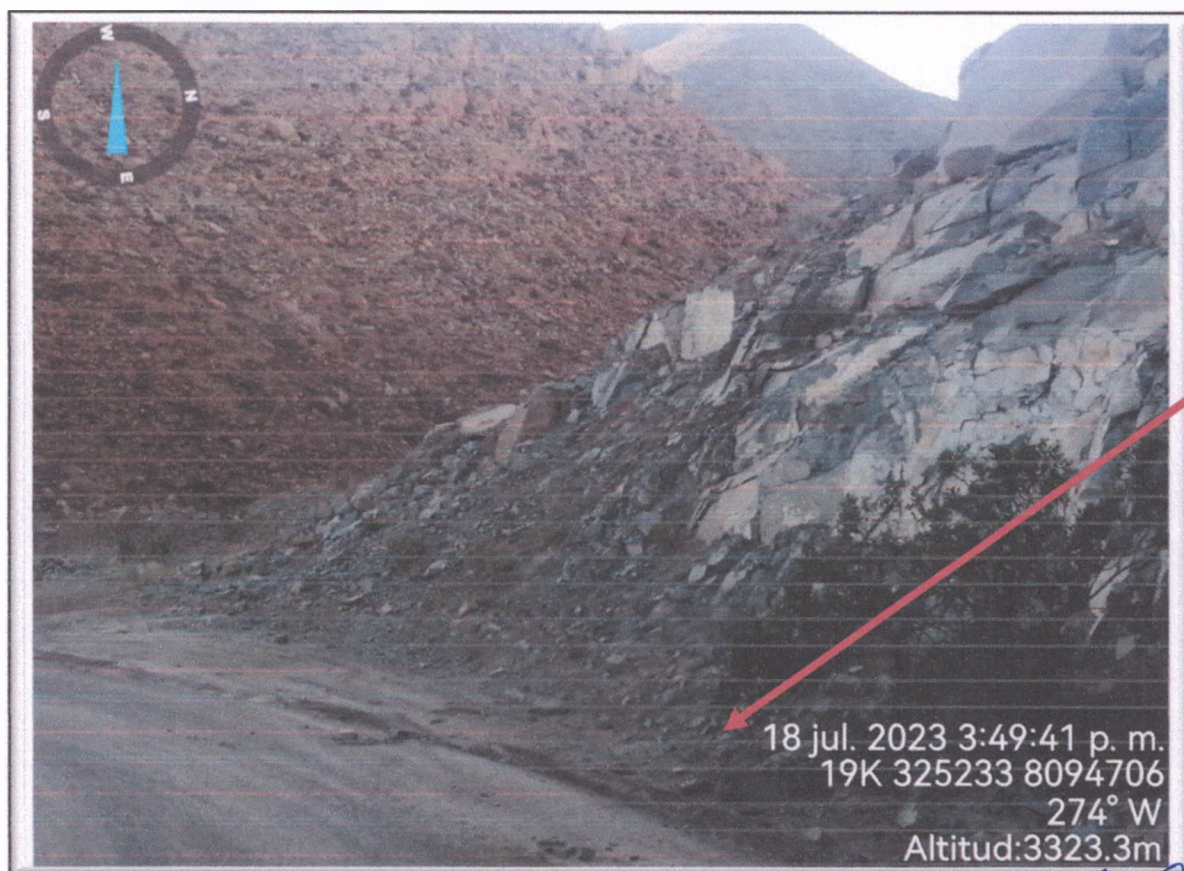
Vista de Cuneta saturada de piedras, arena y tierra en MD.
